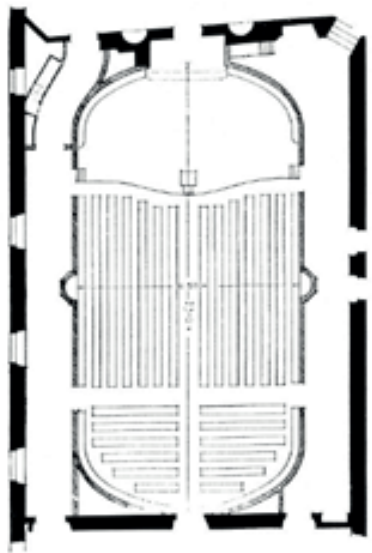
Altes Gewandhaus Leipzig Grundriss
